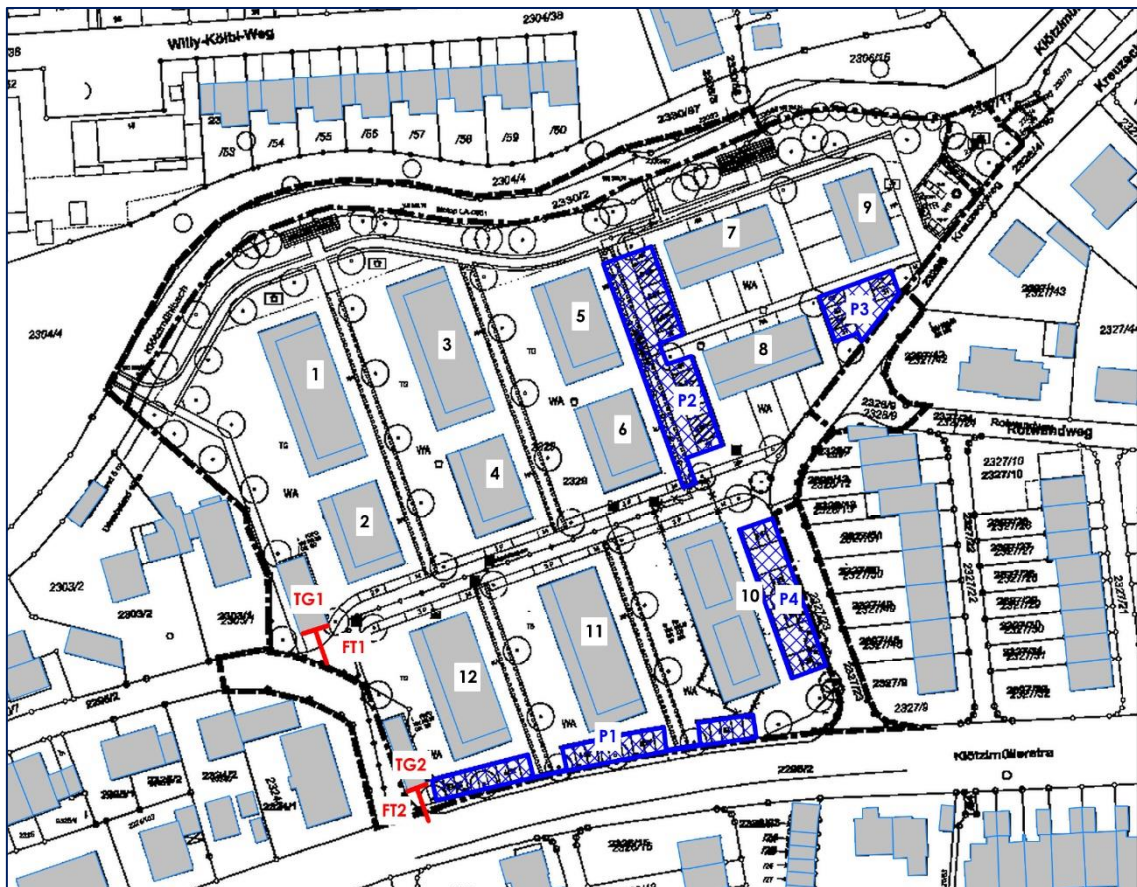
Lageplan mit Darstellung der Schallquellen (Parkplätze + Tiefgaragen)
